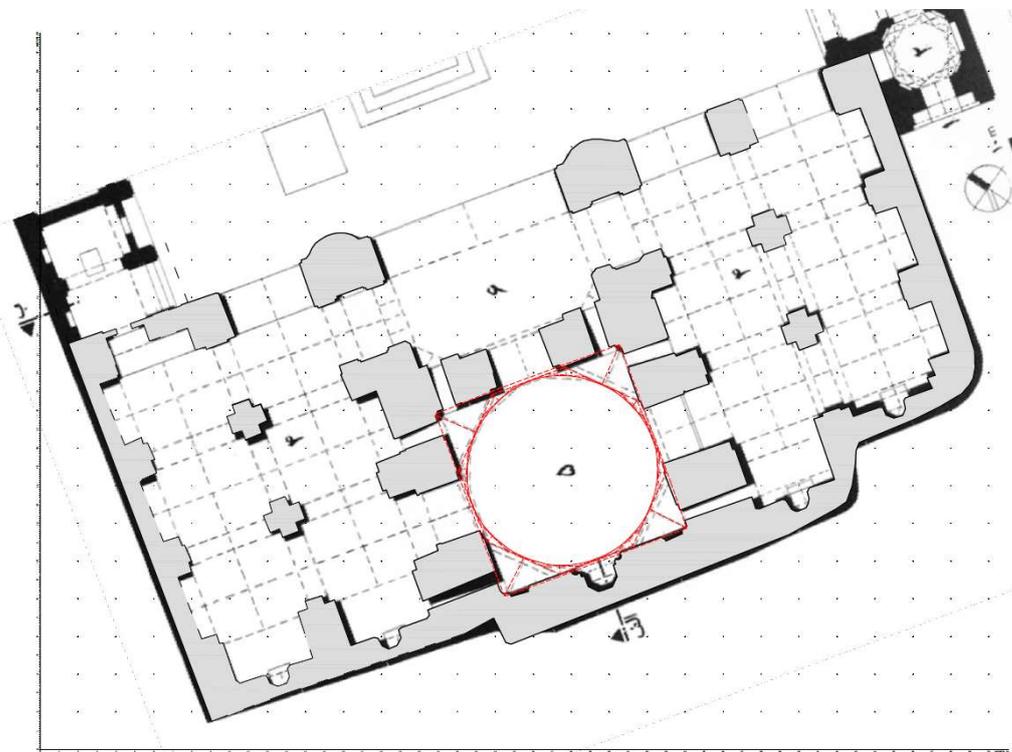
Gegenüberstellung - Bestandsplan, verformungsgerecht zu maßlichem Plan
